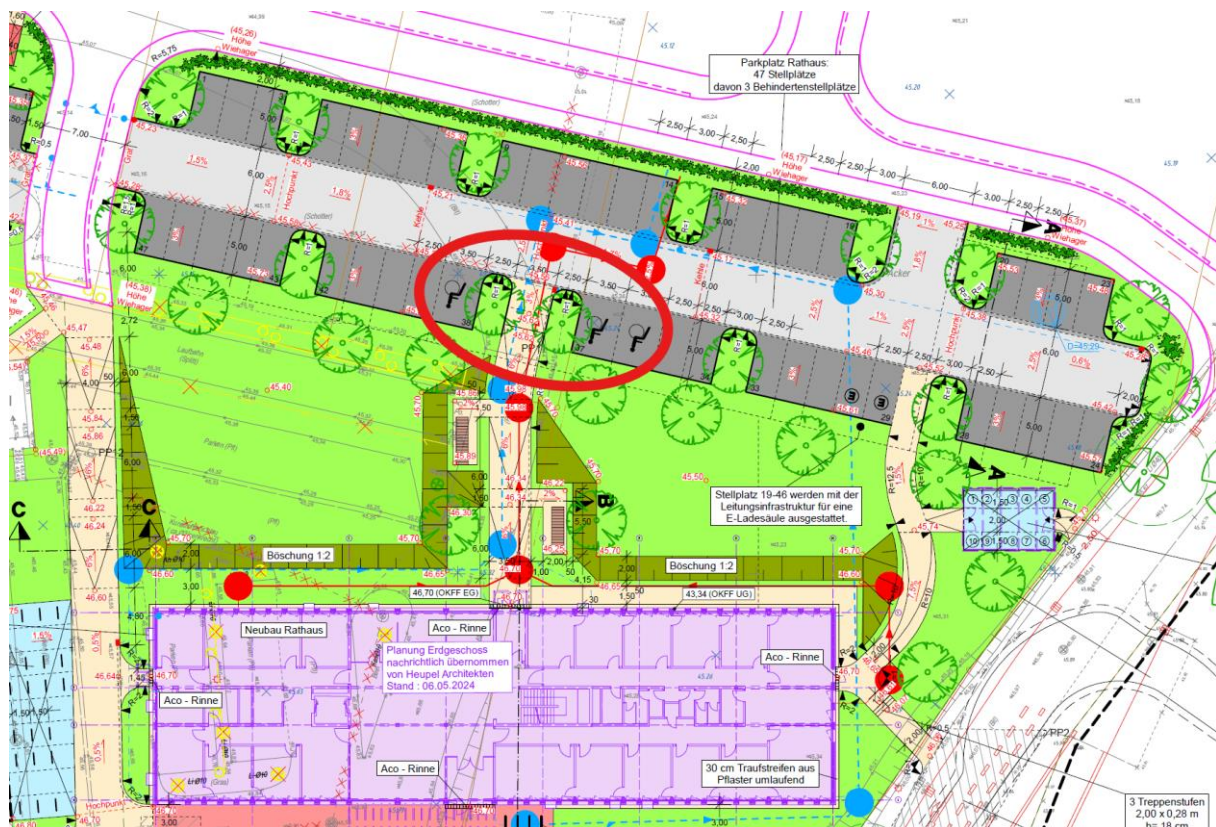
Lageplan (Quelle: Planungsbüro Hahm)
